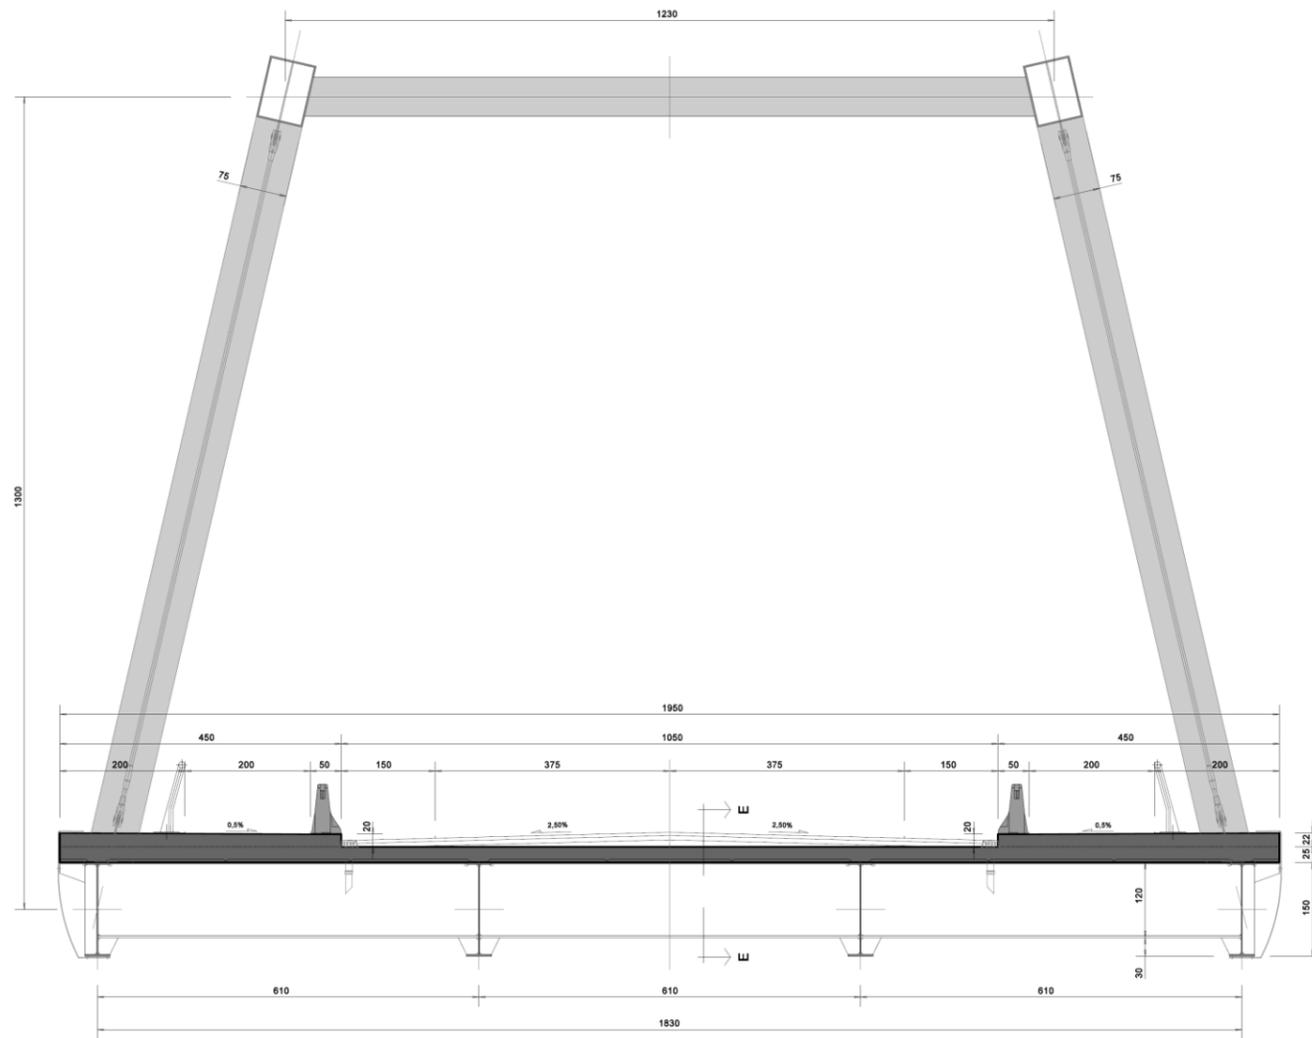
Ponte sul Fiume Oglio – Sezione trasversale in asse
